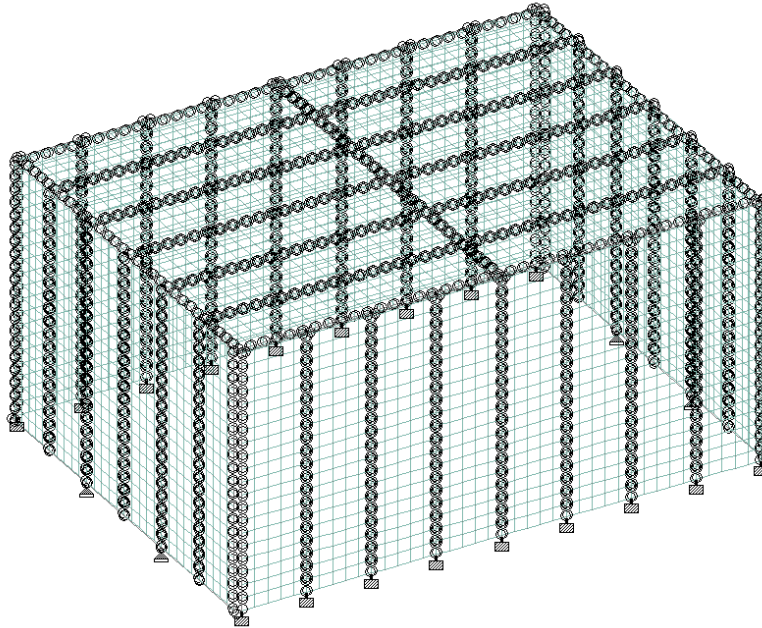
Modelo de cálculo completo con placas "Nave Modular TIPO 2"
